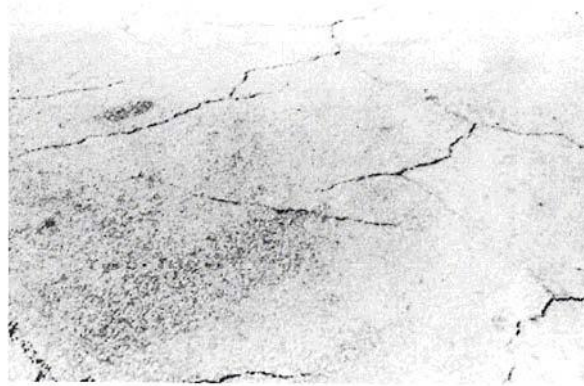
a. Agrietamiento en bloque Baja-severidad.
